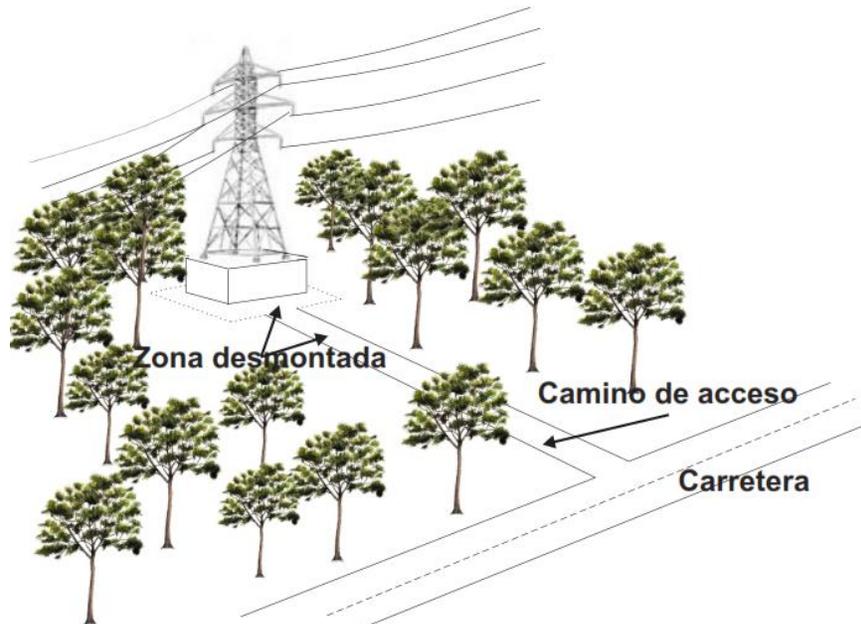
Detalle de construcción de las torres T1 y T2 de la línea de subtransmisión.
